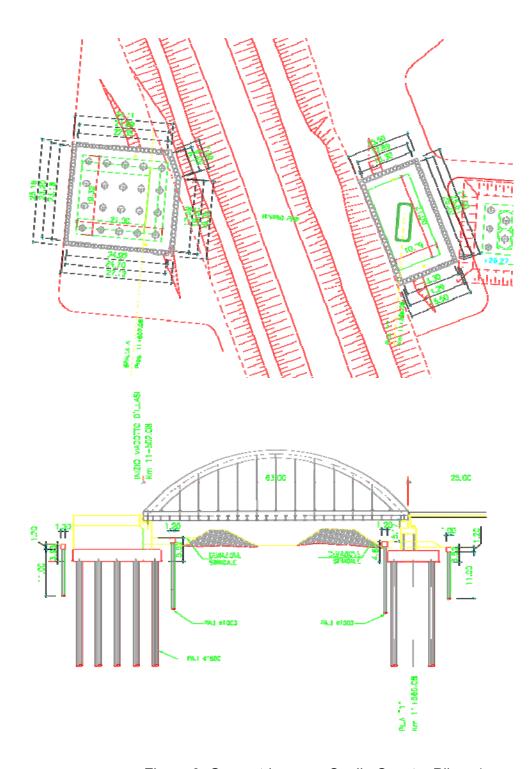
Geometria scavo Spalla Ovest e Pila n.1
